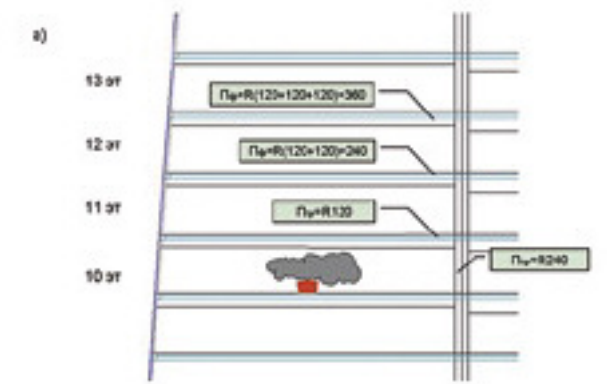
Схема оценки требуемого предела огнестойкости плит перекрытий а) в начальной стадии пожара
